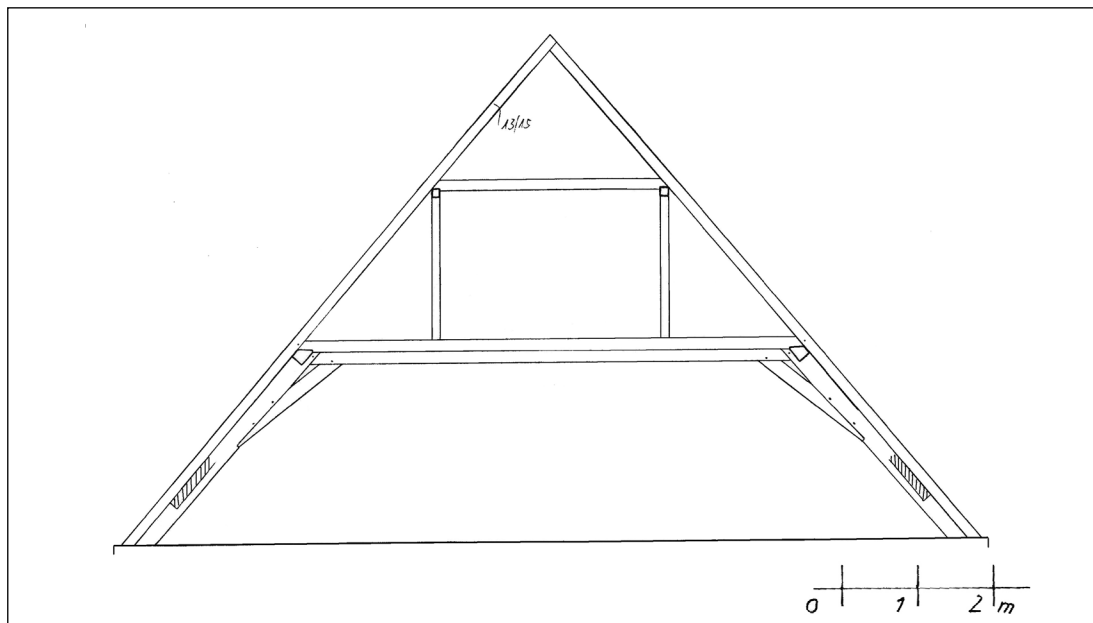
Hauptstraße 42, Querschnitt Dachwerk.
